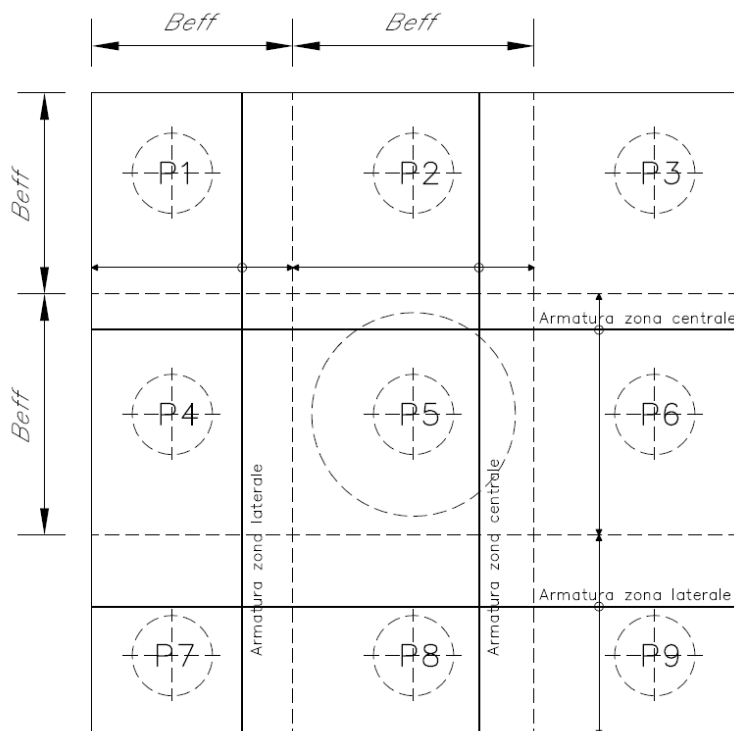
Plinto di fondazione – Armatura longitudinale inferiore e superiore
